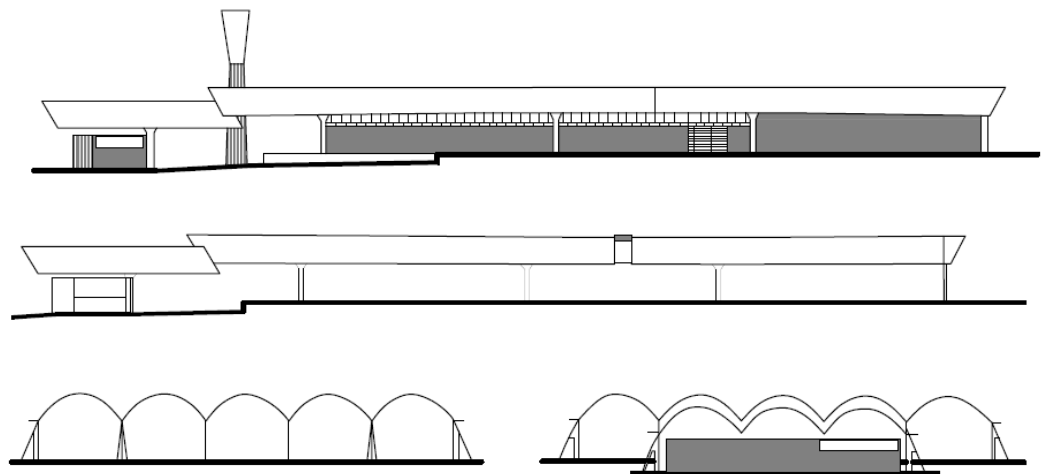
elevação e cortes da Agroindústrias Massaro redesenhados pelo autor.
